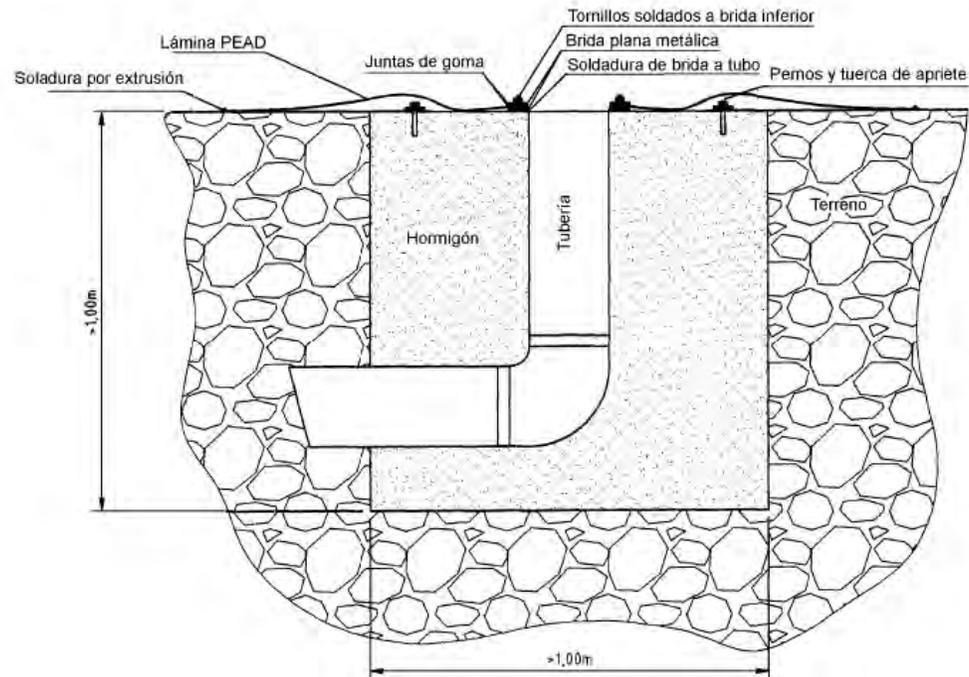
Anclajes a obra de fábrica y a tubería de fondo
